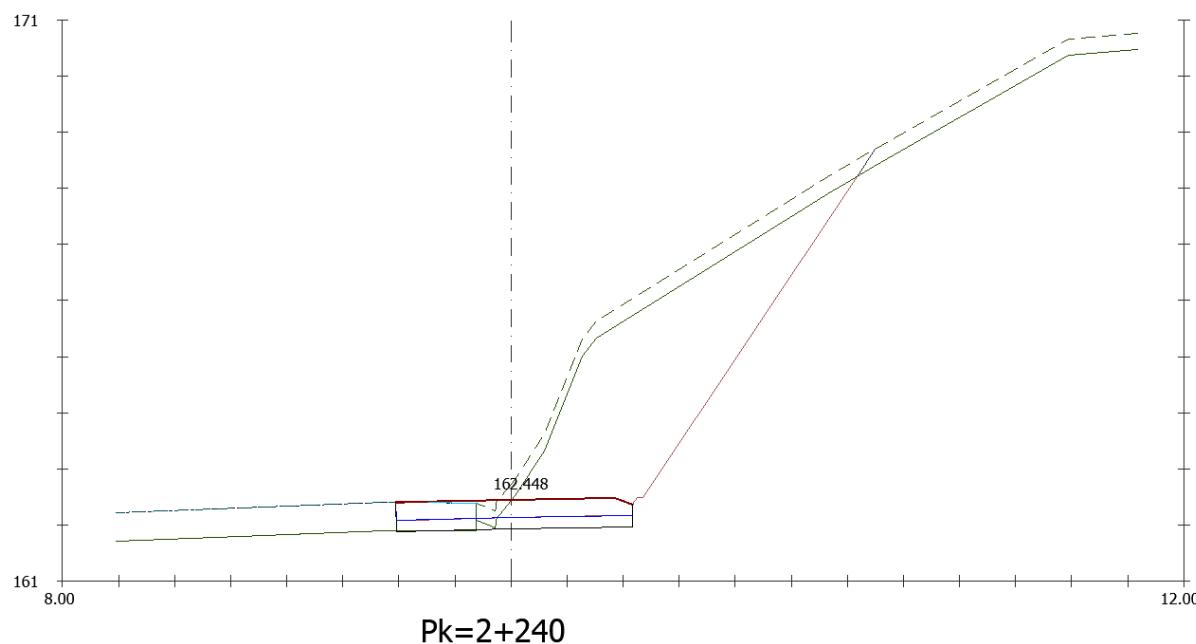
Perfil transversal PK 2+240. Fuente: Plano 6 del proyecto
